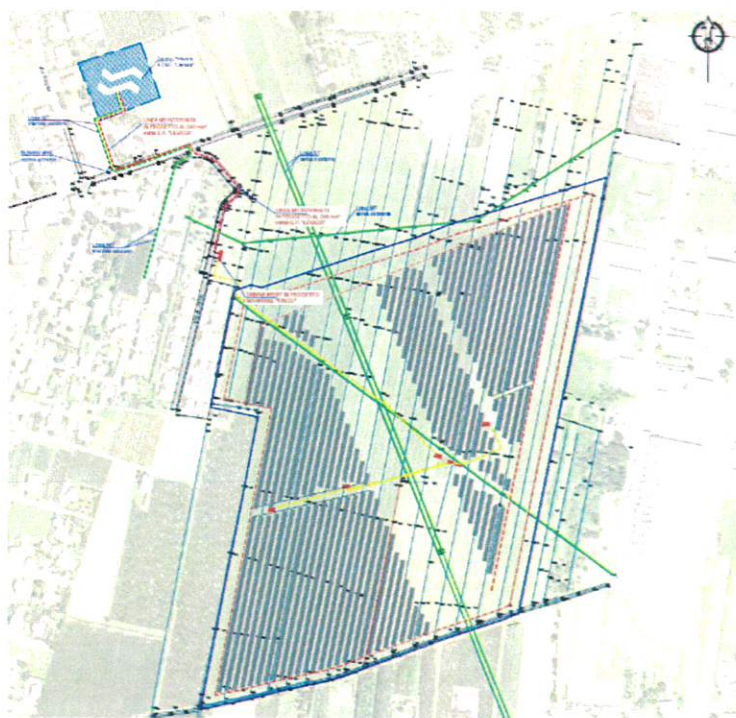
Planimetria di progetto con indicazione dei pannelli e delle principali opere interessate dall'impianto
